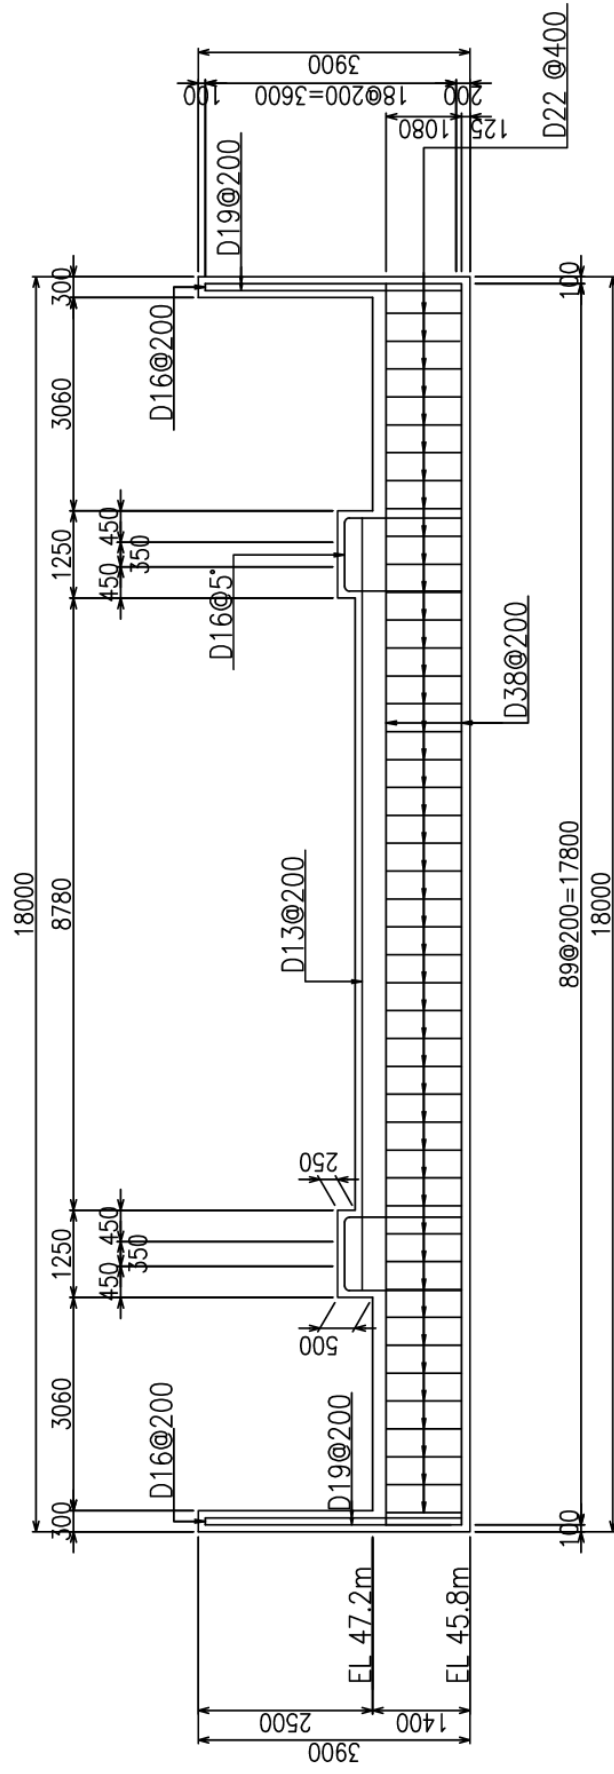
ガスタービン発電機用軽油タンク基礎 平面図
